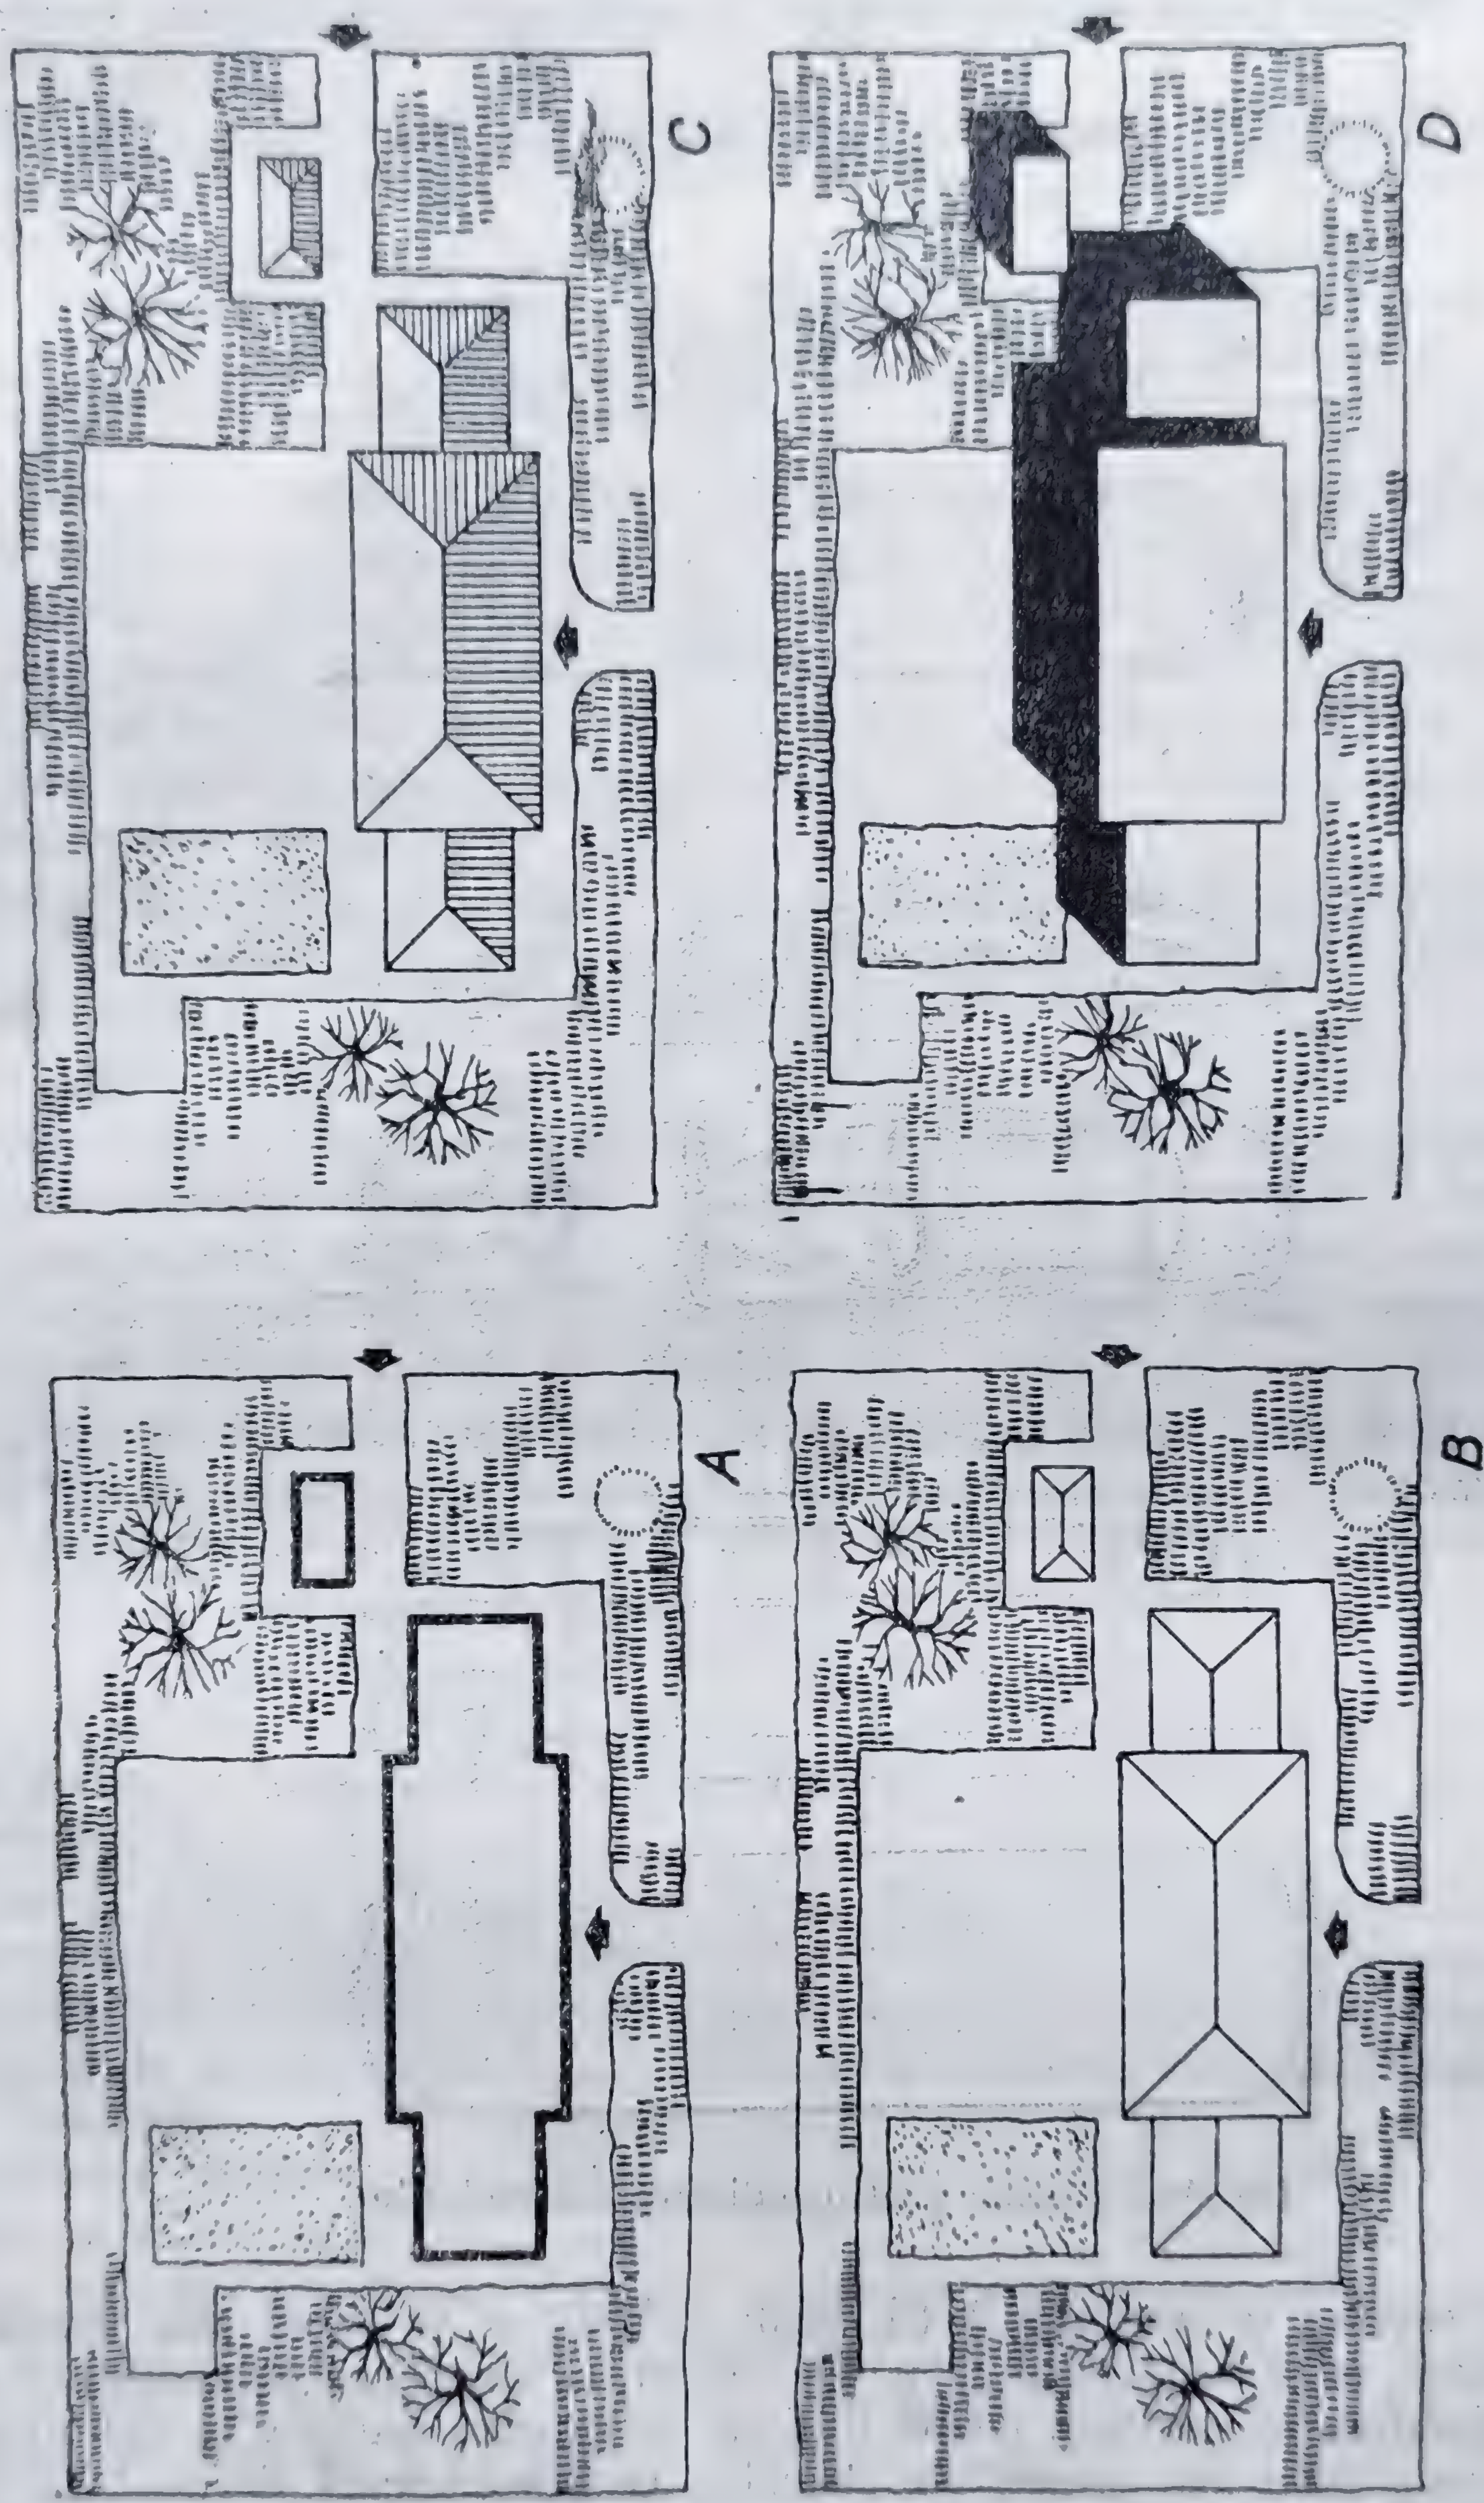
Desenarea construcțiilor în planul de ansamblu:
